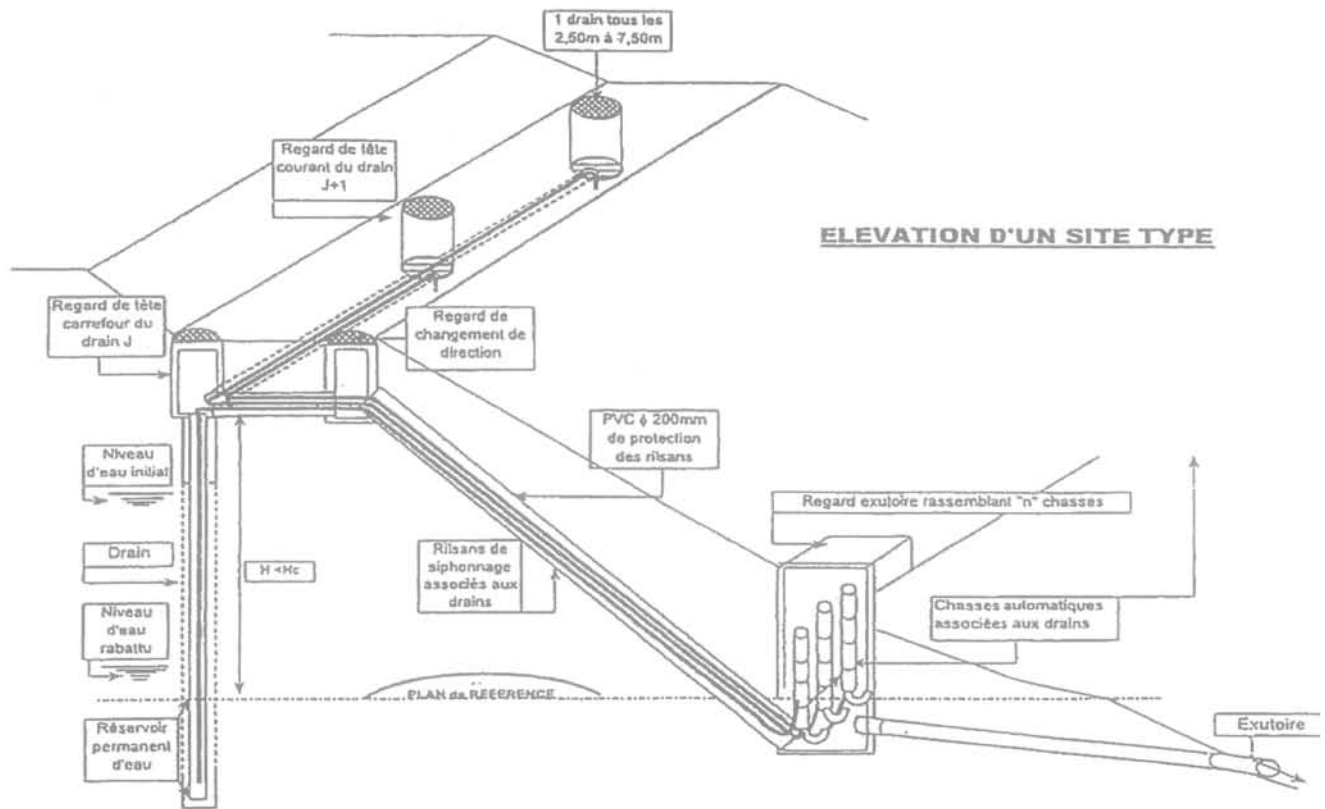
Coupe en travers type sur un réseau de drain siphon.
